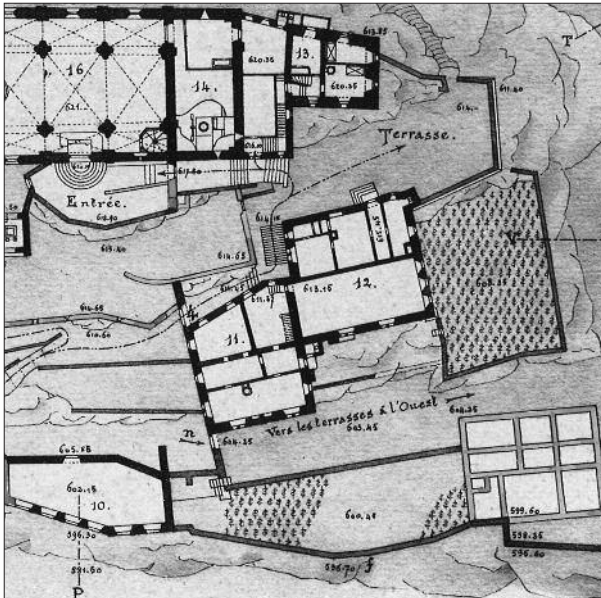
Sion, Valère, Terrasse 4, fouilles 2009. Extrait du plan de Valère dessiné par van Muyden en 1904. La terrasse 4 (à droite) était à cette époque entièrement plantée de vignes.
